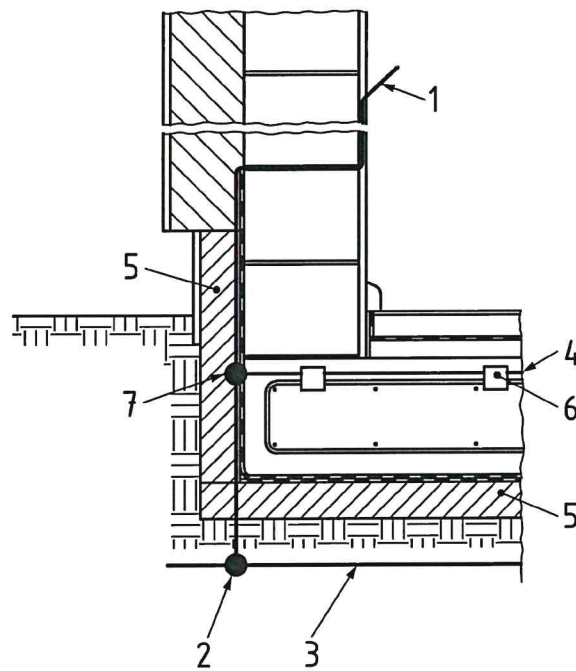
Beispiel für die Anordnung des Ringerders bei wasserundurchlässigem Beton (weiße Wanne) in bewehrtem Fundament
